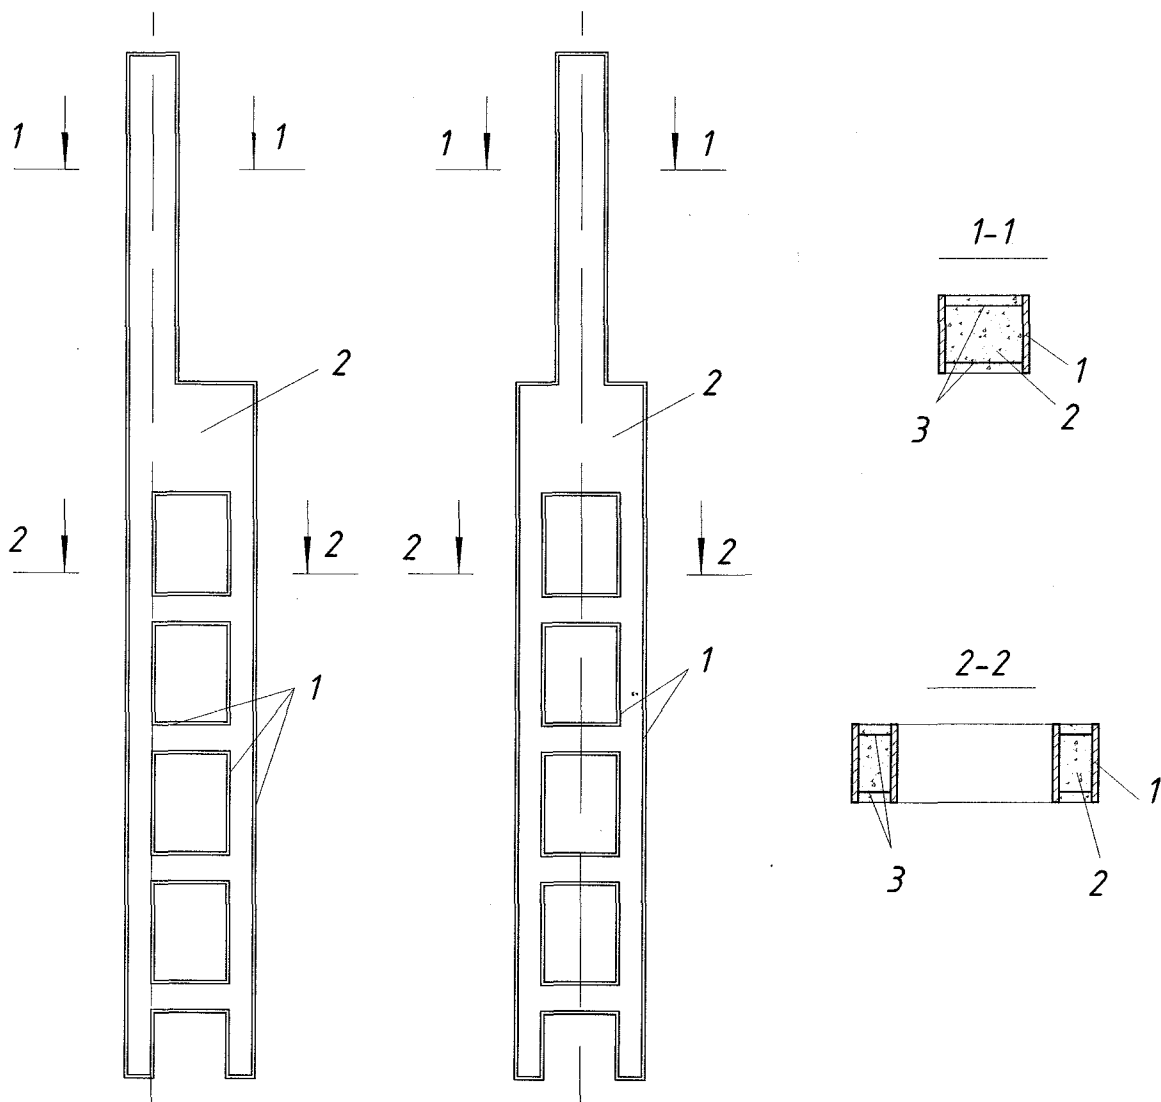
Наскрізна залізобетонна колона із зовнішнім листовим армуванням
